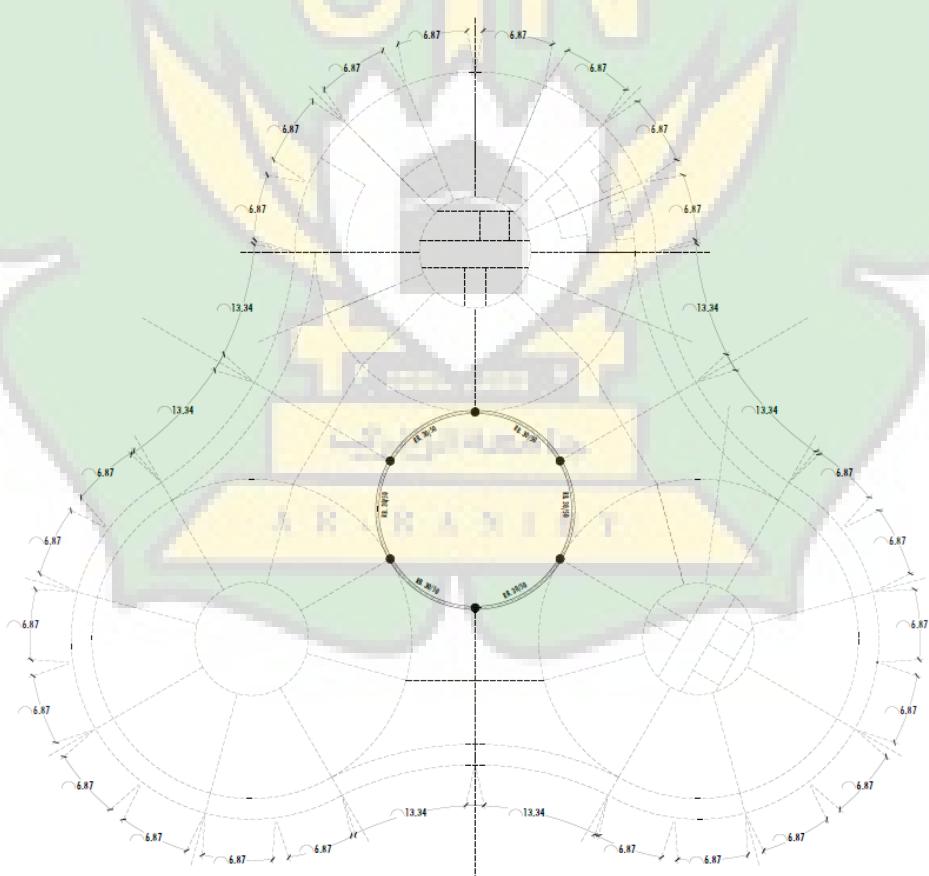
Denah Rencana Kolom Lantai 3
